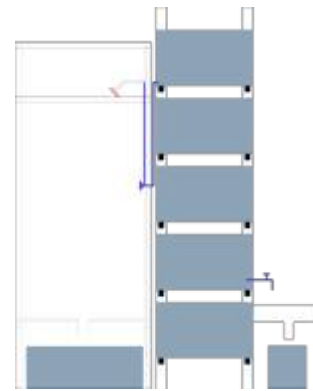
Corte esquemático de regadera. Fuente: Elaboración en equipo.
